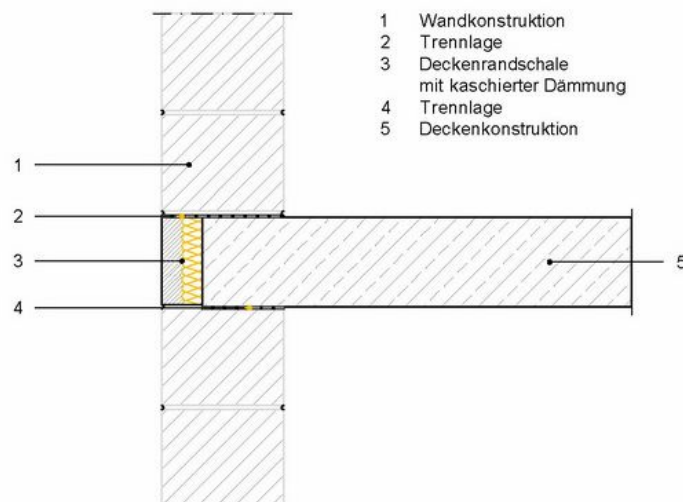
Deckenrandausbildung mit Deckenrandschale
